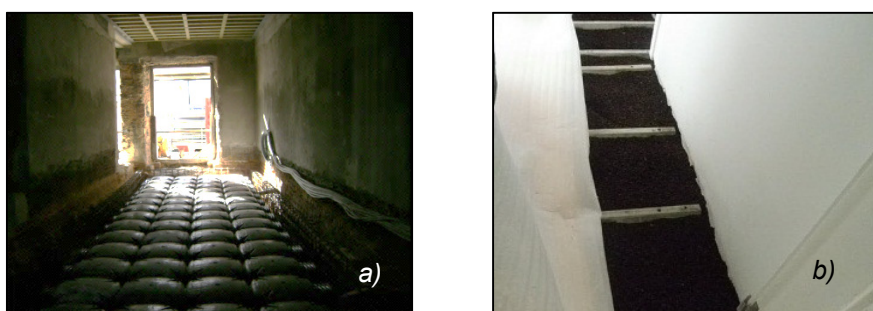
Isolamento de pavimentos térreos: a) laje com moldes vazados (*Obra 6*); b) enchimento com granulado de cortiça expandida (*Obra 10*)
